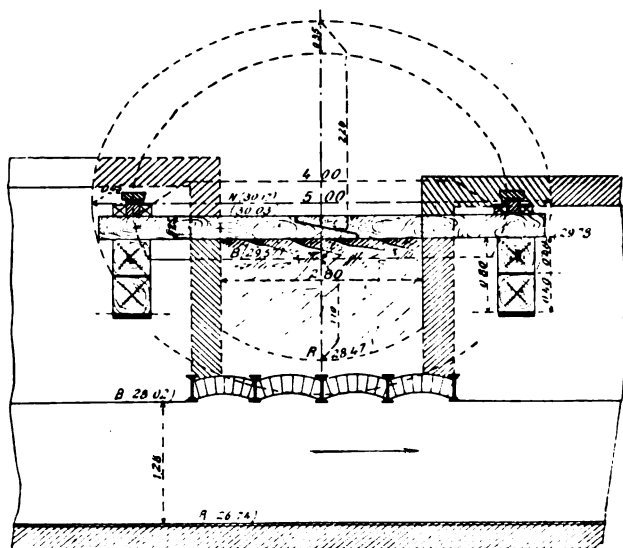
Franchissement du collecteur de l'Université. Coupe du plancher transversalement au collecteur de Bièvre.
